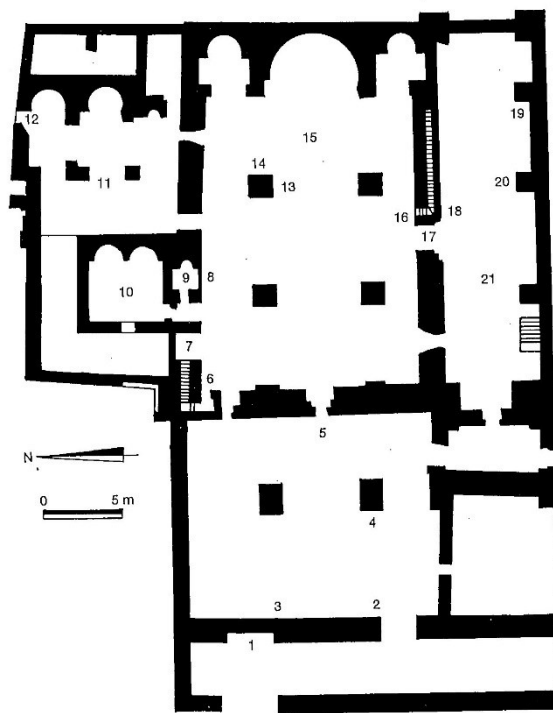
Grundriss der Kathedrale ²³⁾
